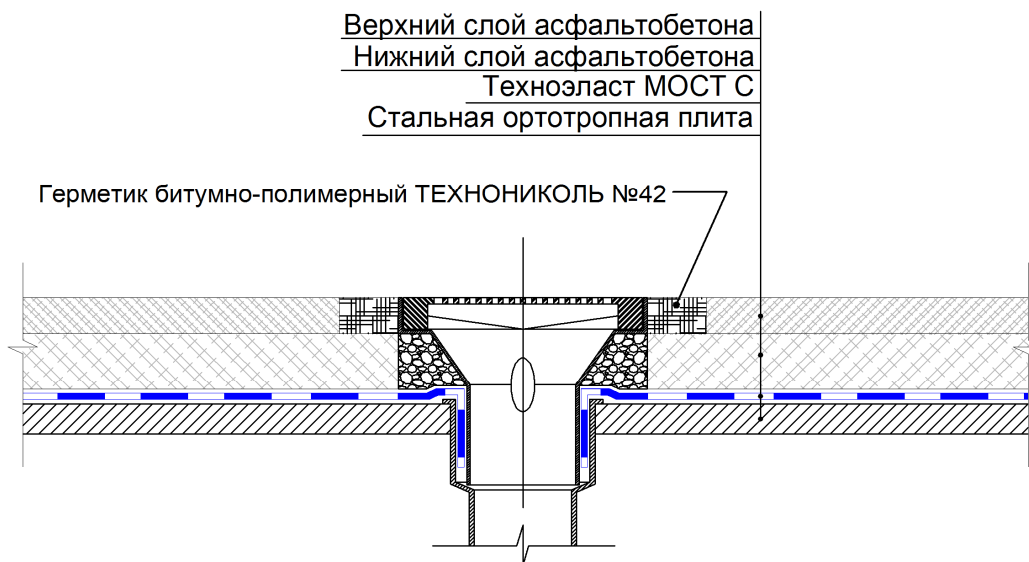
Сопряжение гидроизоляции с водоотводной трубкой.
